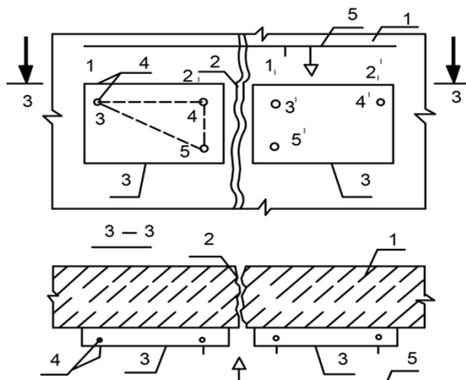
Маяк конструкции Белякова: 1 – строительная конструкция; 2 – трещина; 3 – прямоугольные гипсовые или алебастровые пластины; 4 – металлические шпильки с острыми концами; 5 – измеритель линейных размеров
